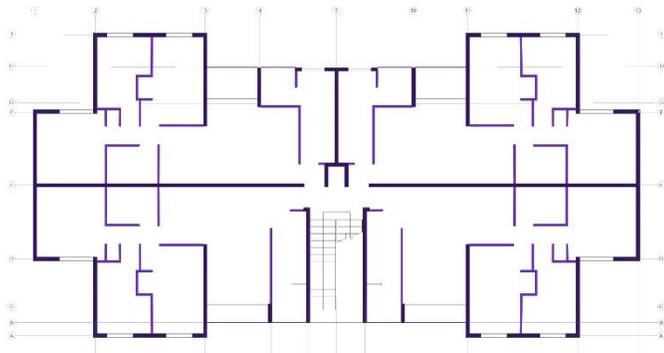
Estructura Don Eduardo. Fuente: Elaboración propia
